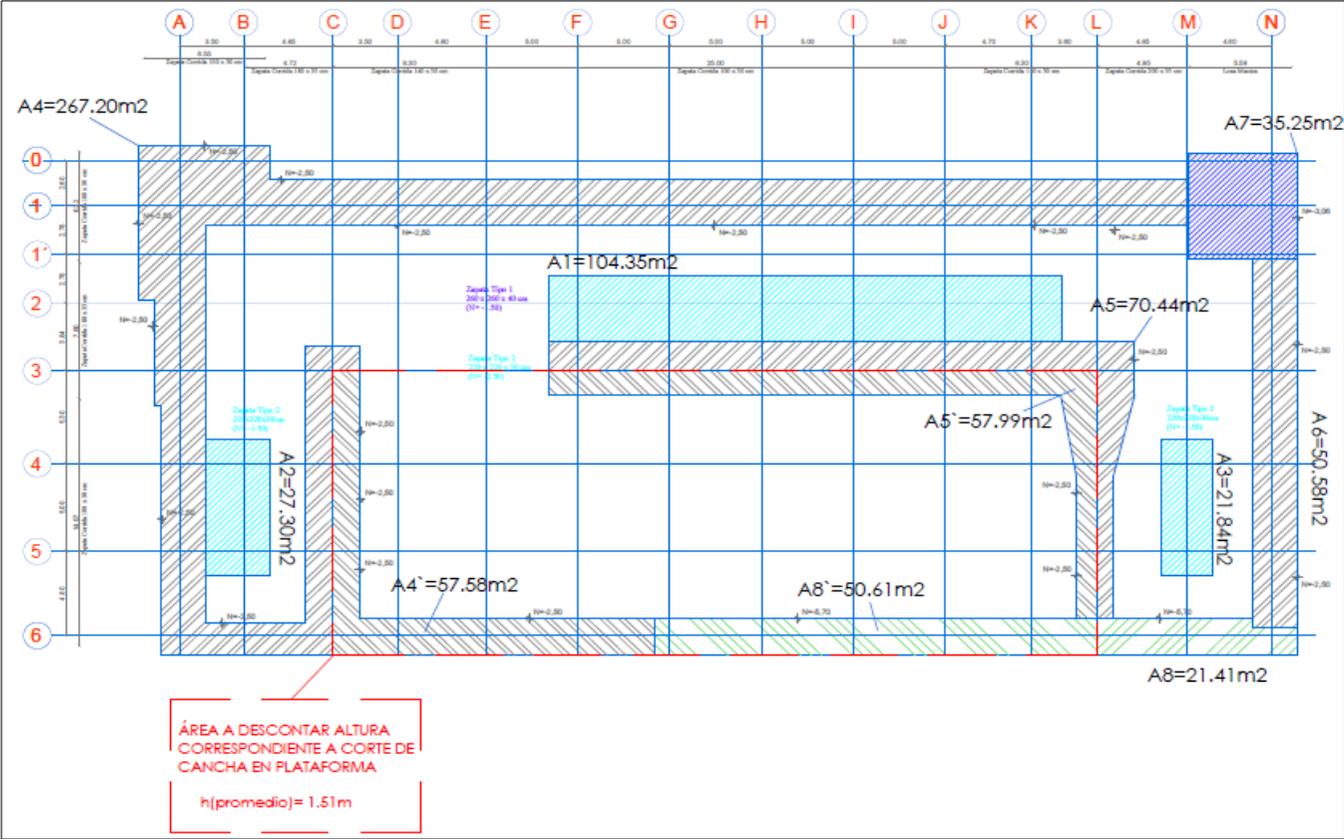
Planta de cimentación de diseño inicial. Fuente: AutoCad-2015
